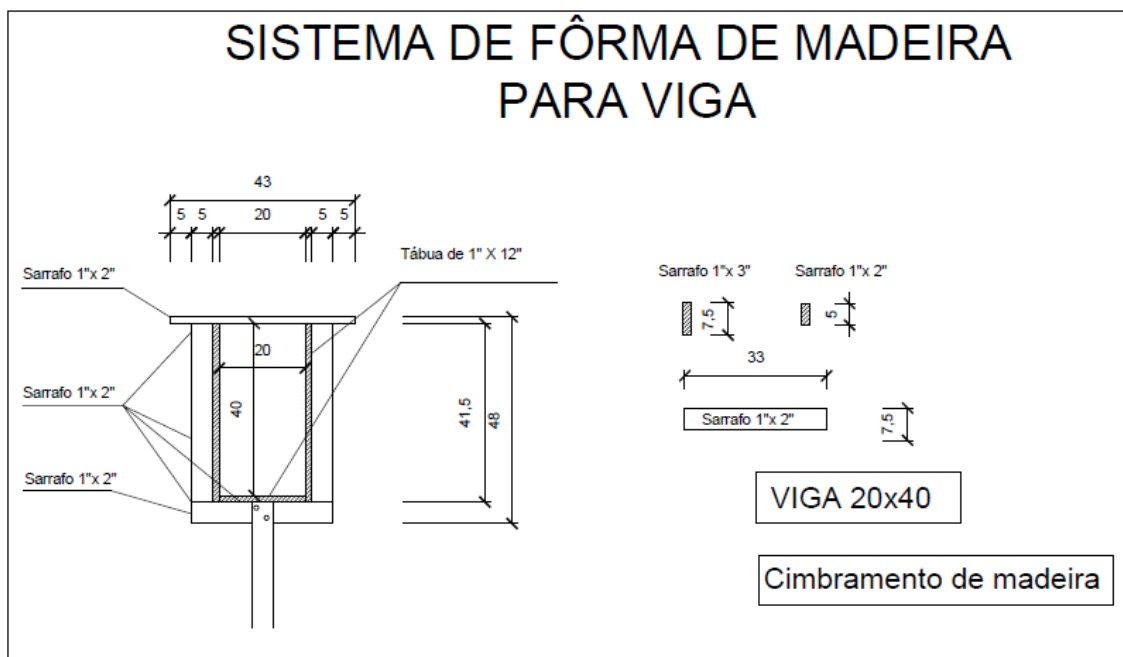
Modelo 02 de fôrma para viga de concreto armado.
